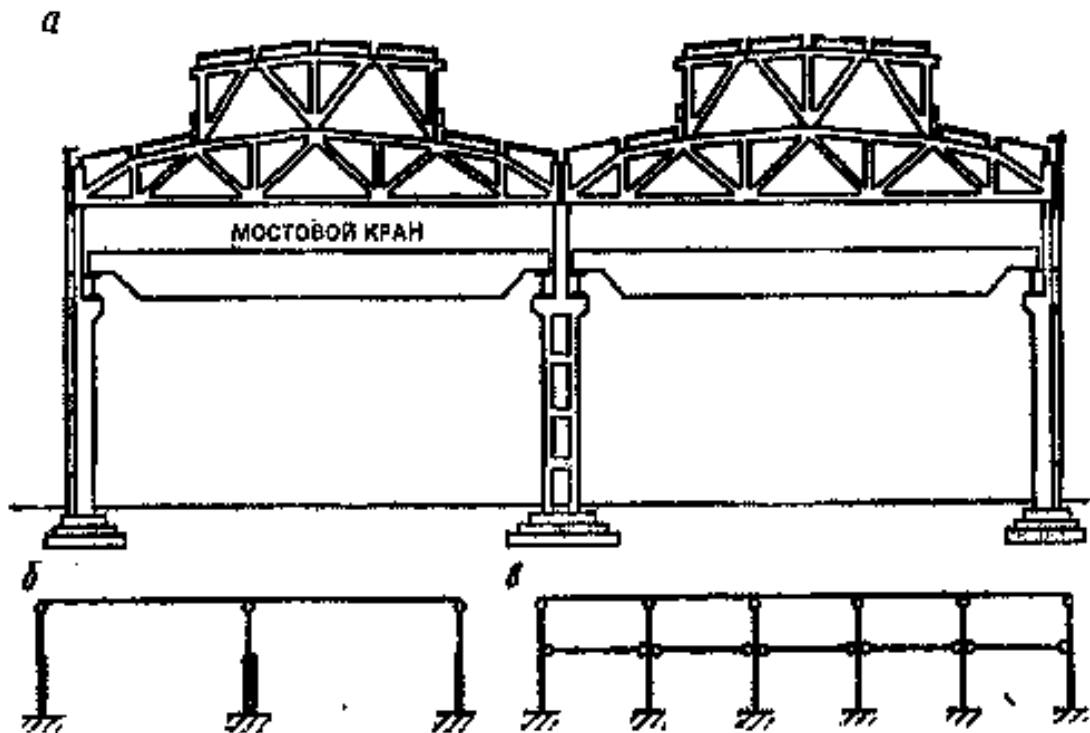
Одноэтажное промышленное здание с мостовыми кранами:
